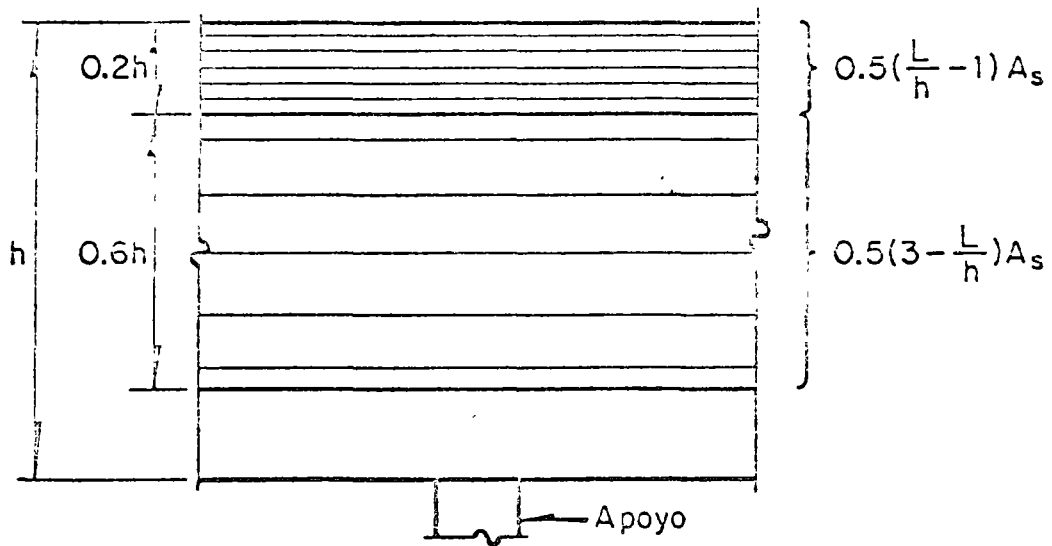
Franjas en que se distribuye el refuerzo negativo A_s , en una viga diafragma continua con $L/h \geq 1.0$
